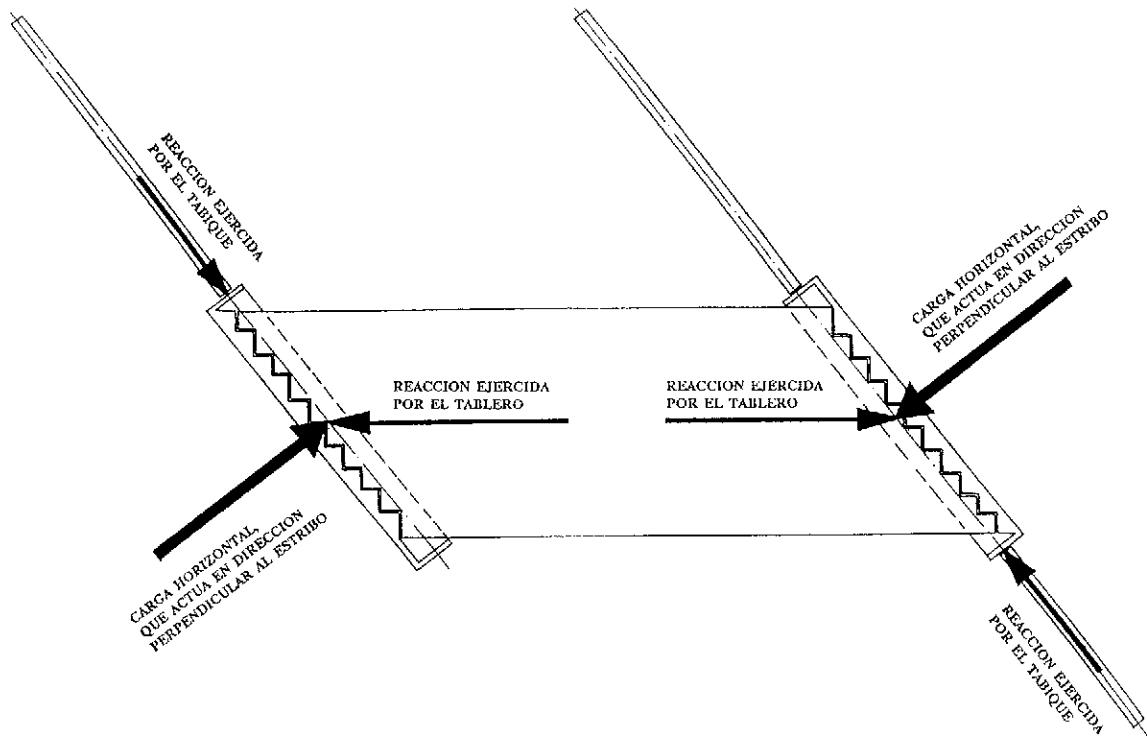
Puente de F.C. sobre la Carretera N-630, en Béjar. Esquema de transmisión de cargas horizontales, no alineadas con el eje longitudinal del tablero.
